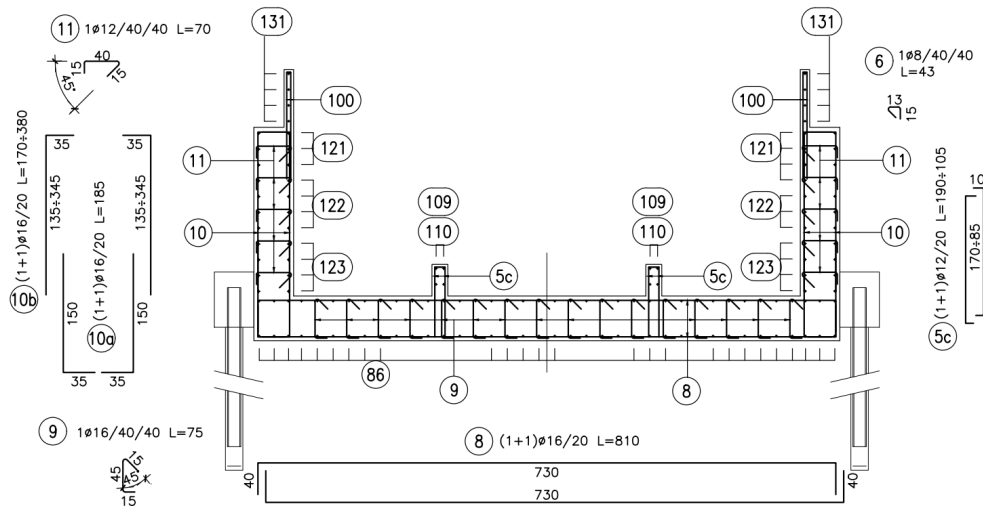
Sezione fondazione e muri scale stazione metropolitana
